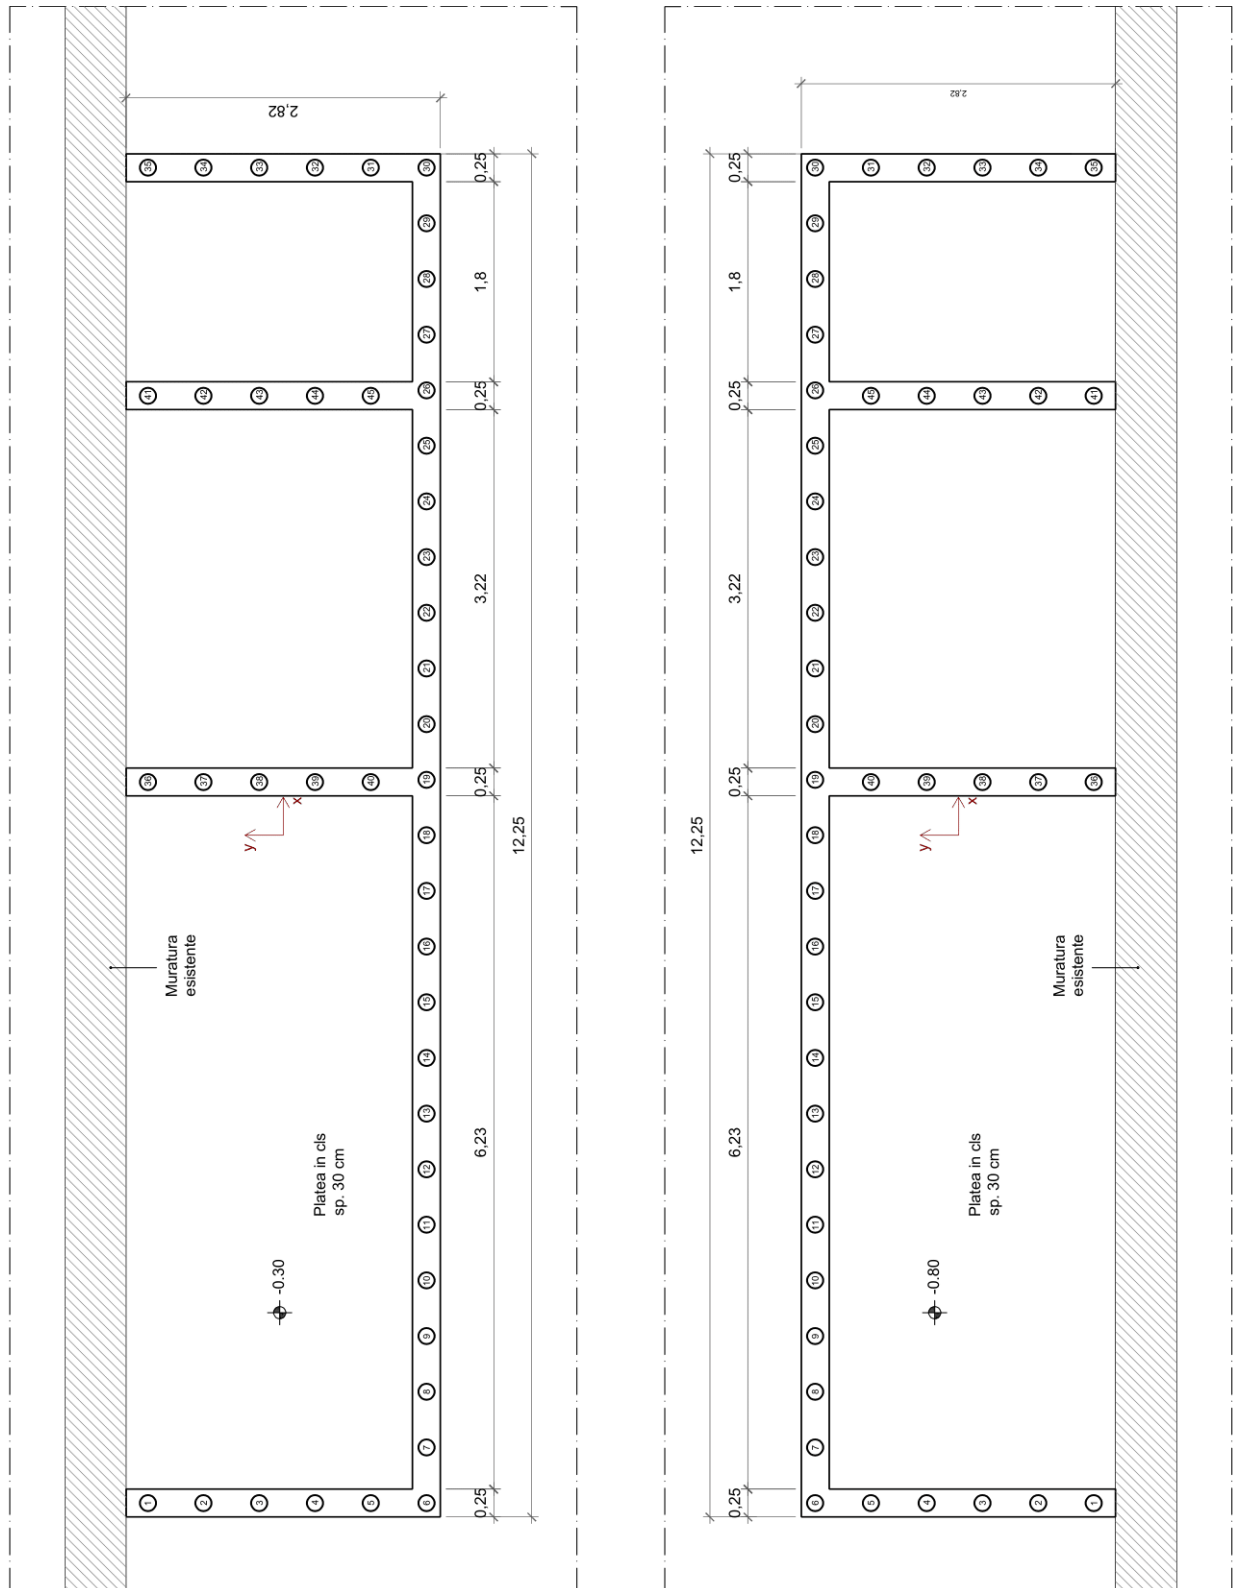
Disposizione planimetrica dei micropali - scale C, D.
